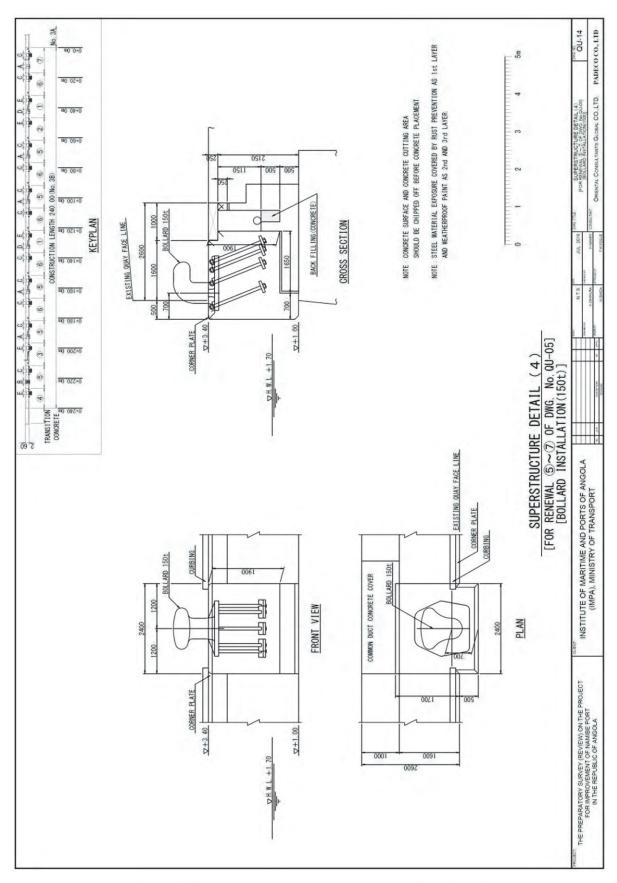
Planta Detalhada da Estrutura Superior (2)
